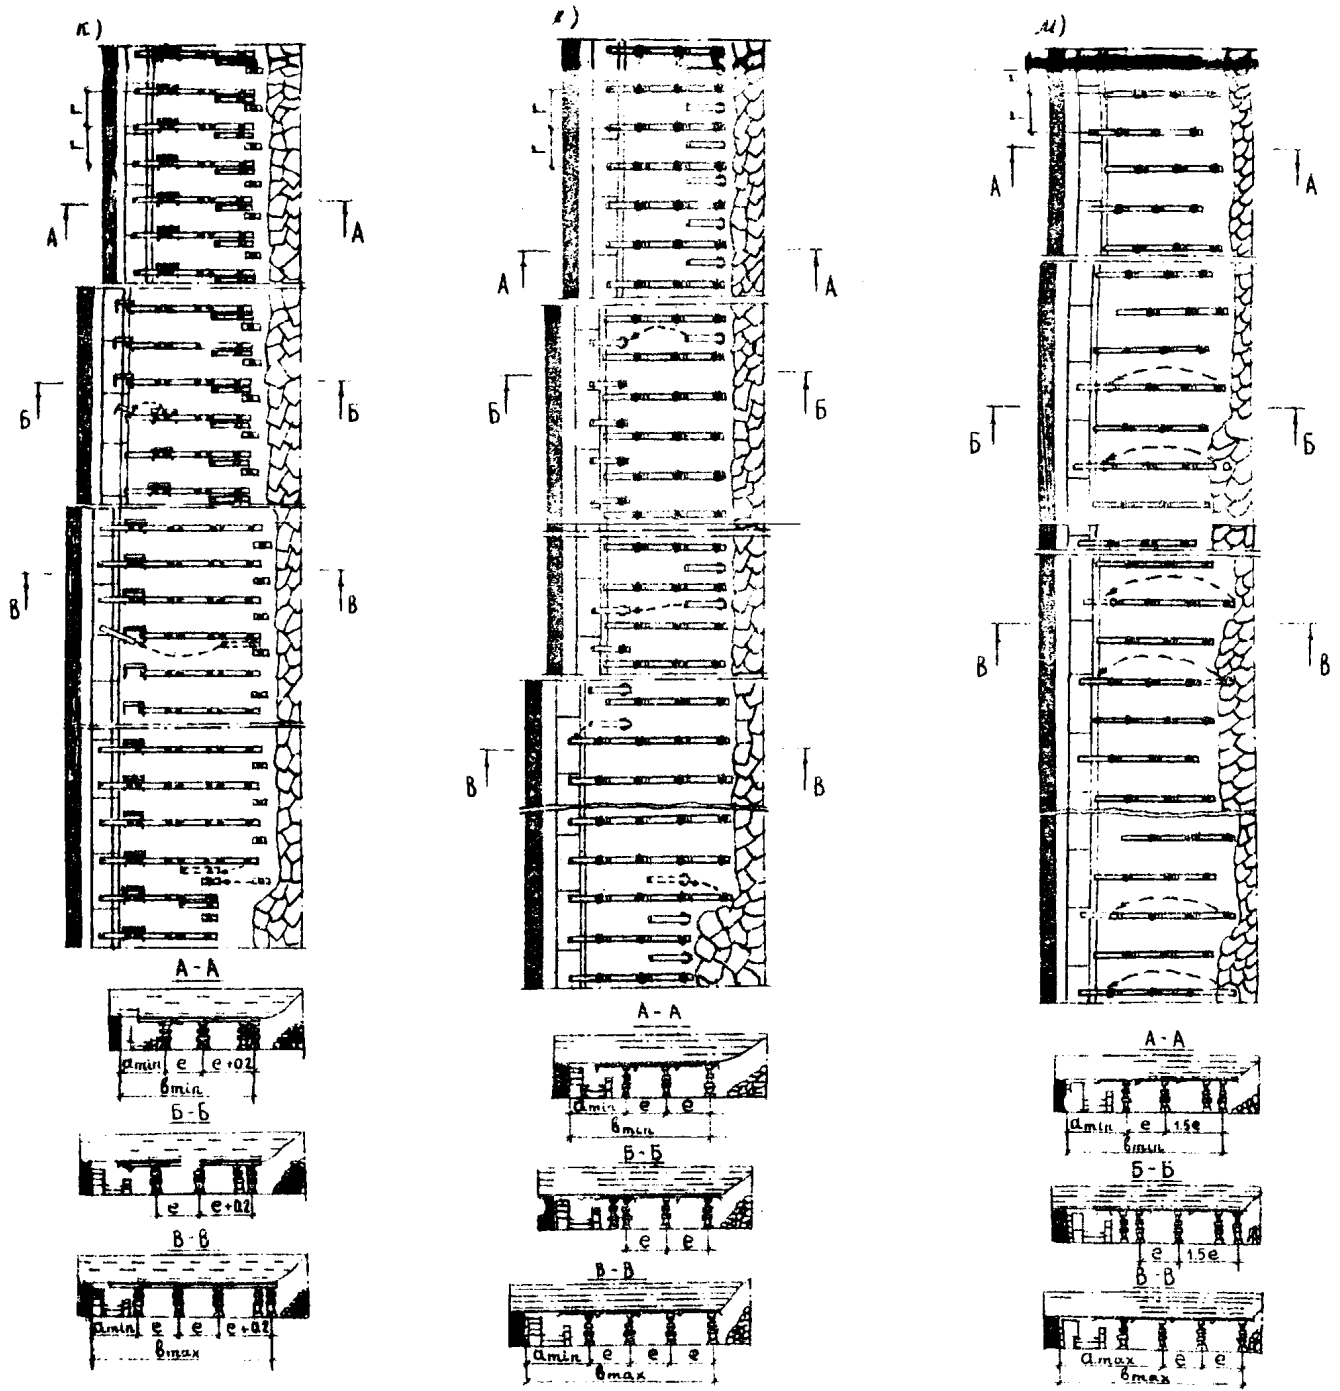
Схемы крепления струговых дам индивидуальными креплениями.
